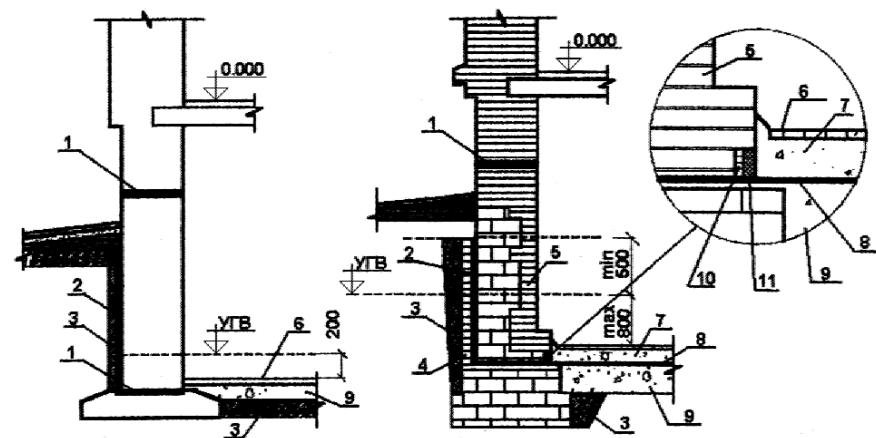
Гидроизоляция фундаментов от напорной грунтовой воды.
